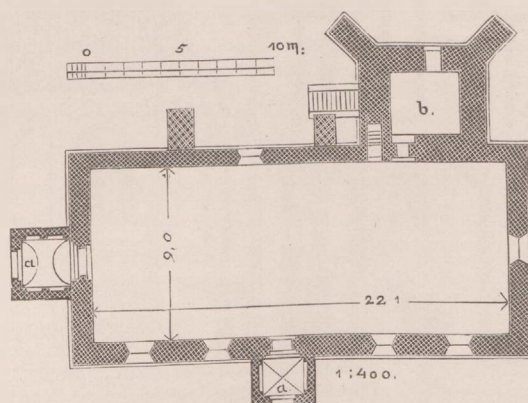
Okonin. Grundriss der Kirche.
